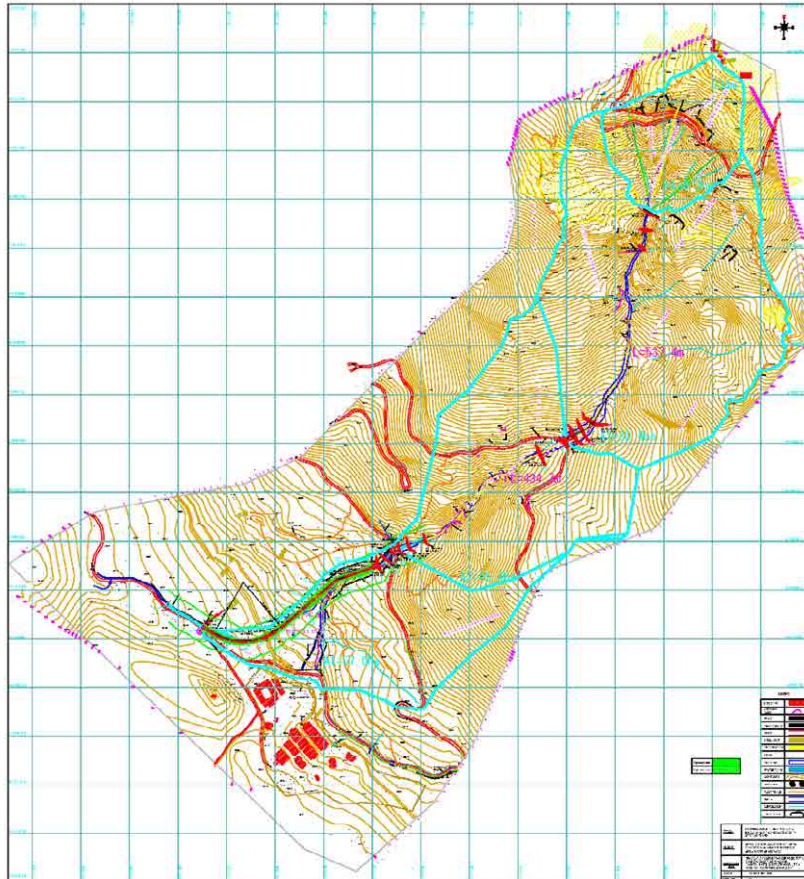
Jokla 平面図(対策工:最上部山腹工鋼製ネット及び層厚吹付工 21,575 m<sup>2</sup>、溪流内谷止工 12 基、流路工 403.2m)
